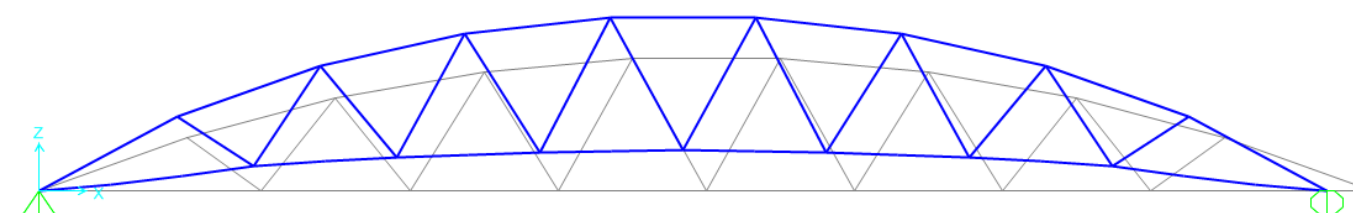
Levantamiento de la pasarela tras tesoado final de vigas longitudinales
